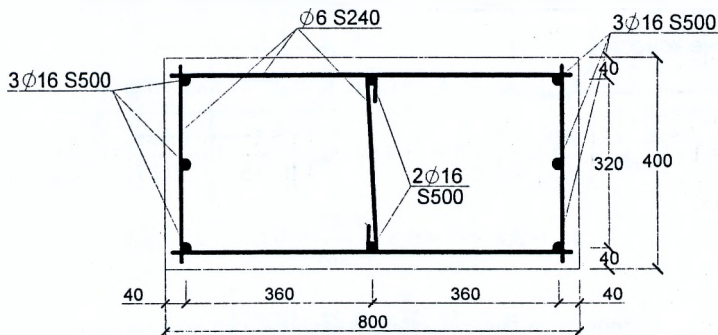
Армирование сечения подкрановой части колонны
